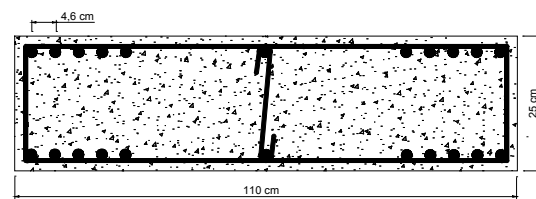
Caso 2: Arranjo das armaduras na seção transversal.
